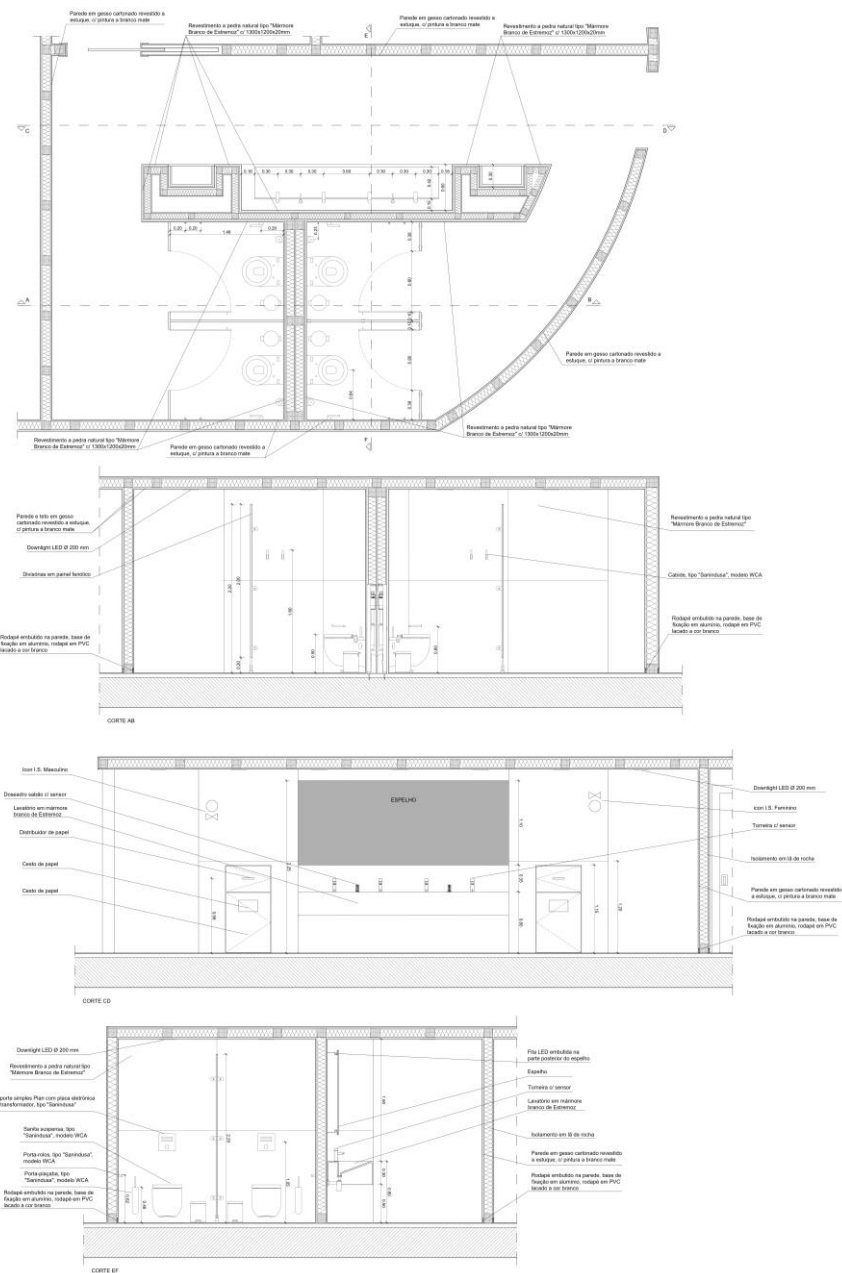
Desenho Técnico - Pormenorização Instalação Sanitária. Fonte: (Autor)
